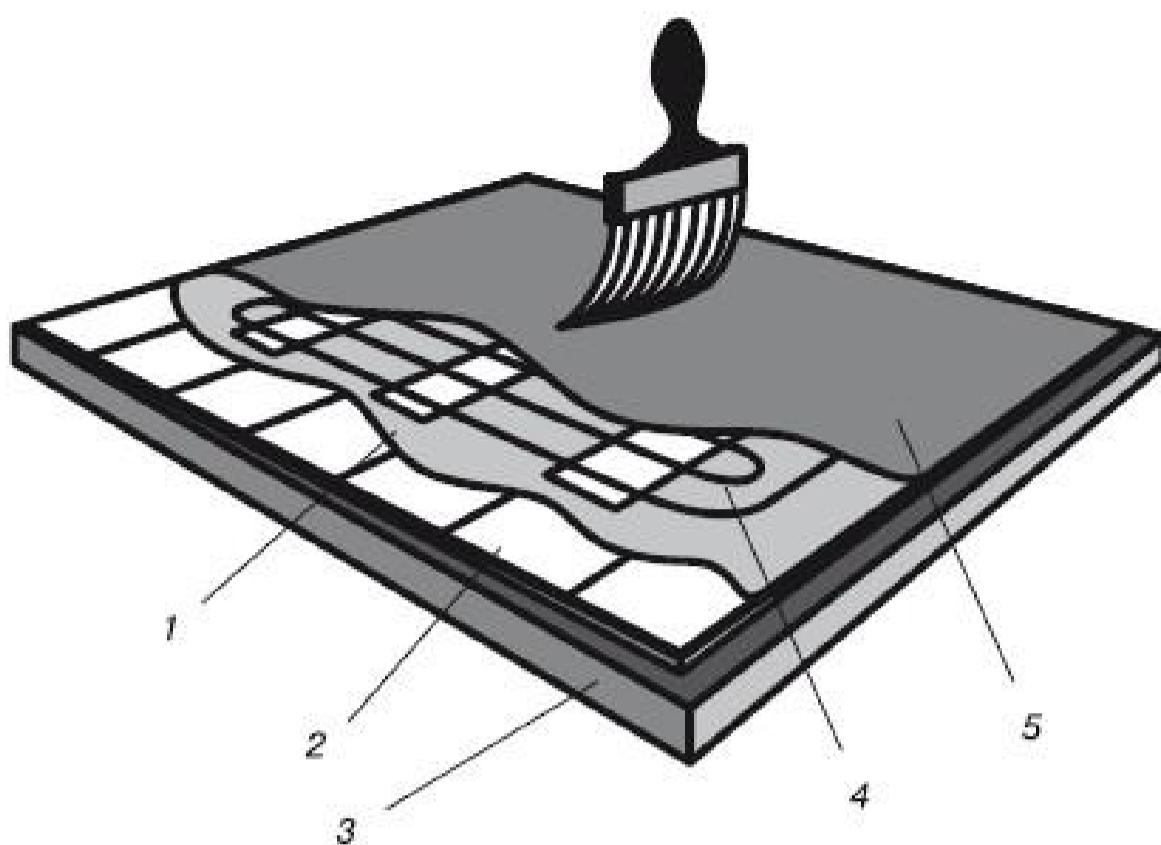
Нанесение раствора для крепления плитки на нагревательный мат: 1 – грунтовый слой клея; 2 – старая плитка; 3 – основа пола; 4 – нагревательный мат; 5 – раствор для крепления плитки
